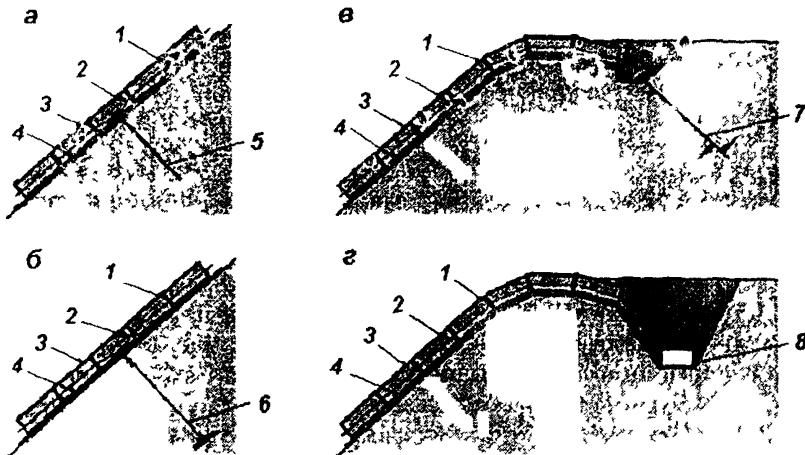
Схема анкерных креплений «Геовеба» а – поверхностная анкеровка стержнями с ATP-клипом, б – то же, стержнями с заглубленным шарниром, в – анкеровка на верху откоса (склона) шнековыми анкерами, г – то же анкерными столбами (грузами), 1 – стенка «Геовеба», 2 – трос, 3 – заполнитель, 4 – геотекстиль, 5 – анкерный стержень с ATP-клипом, 6 – анкерный стержень с заглубленным шарниром, 7 – шнековый анкер, 8 – анкерный столб (груз)
